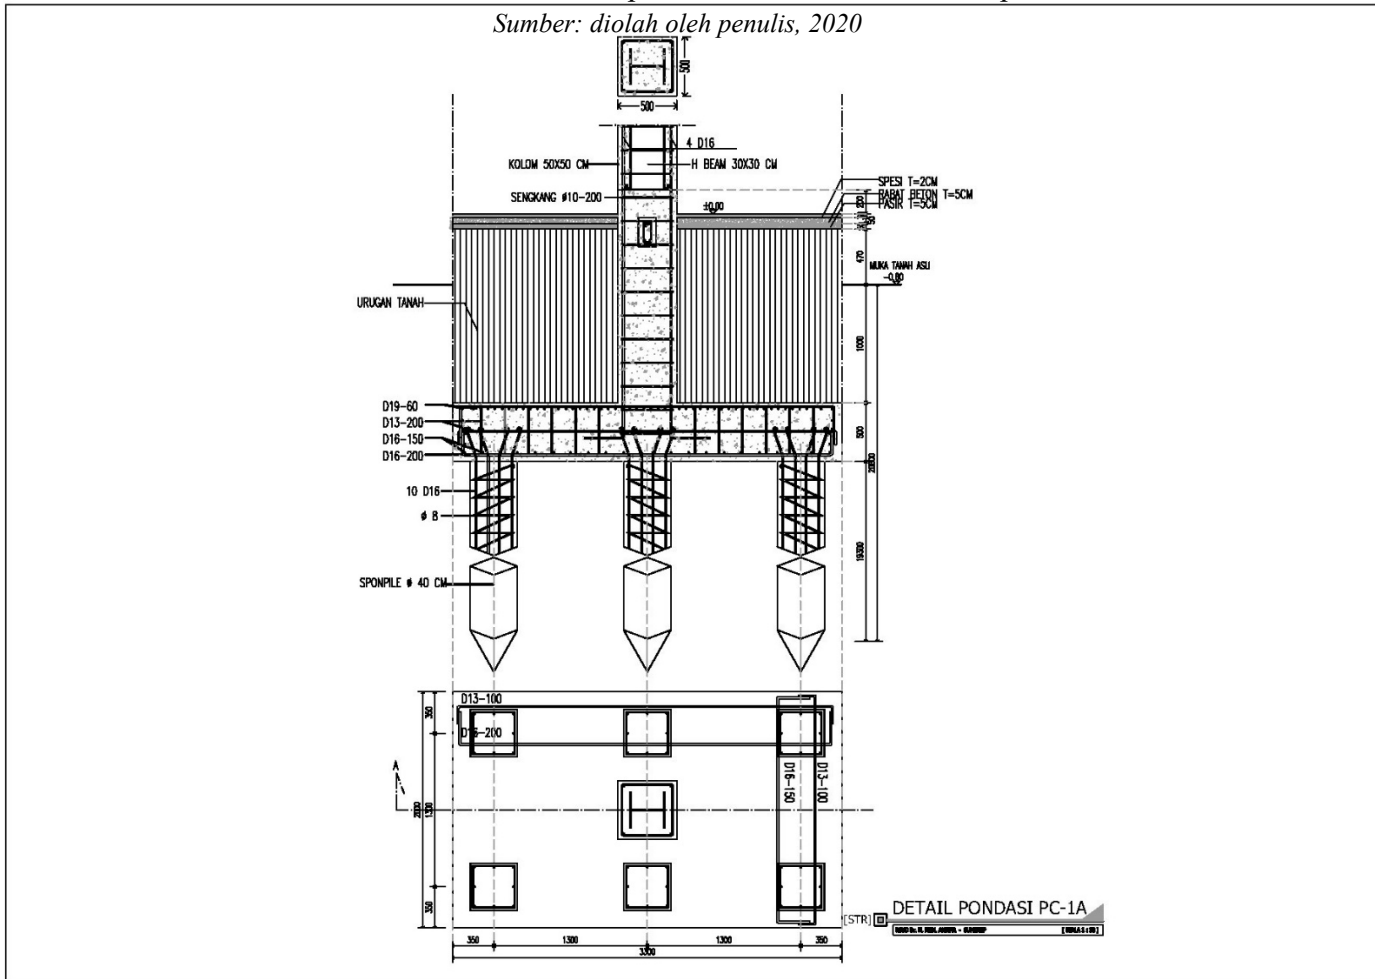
Denah Pile Cap untuk Alternatif 1 Pondasi Spun Pile
